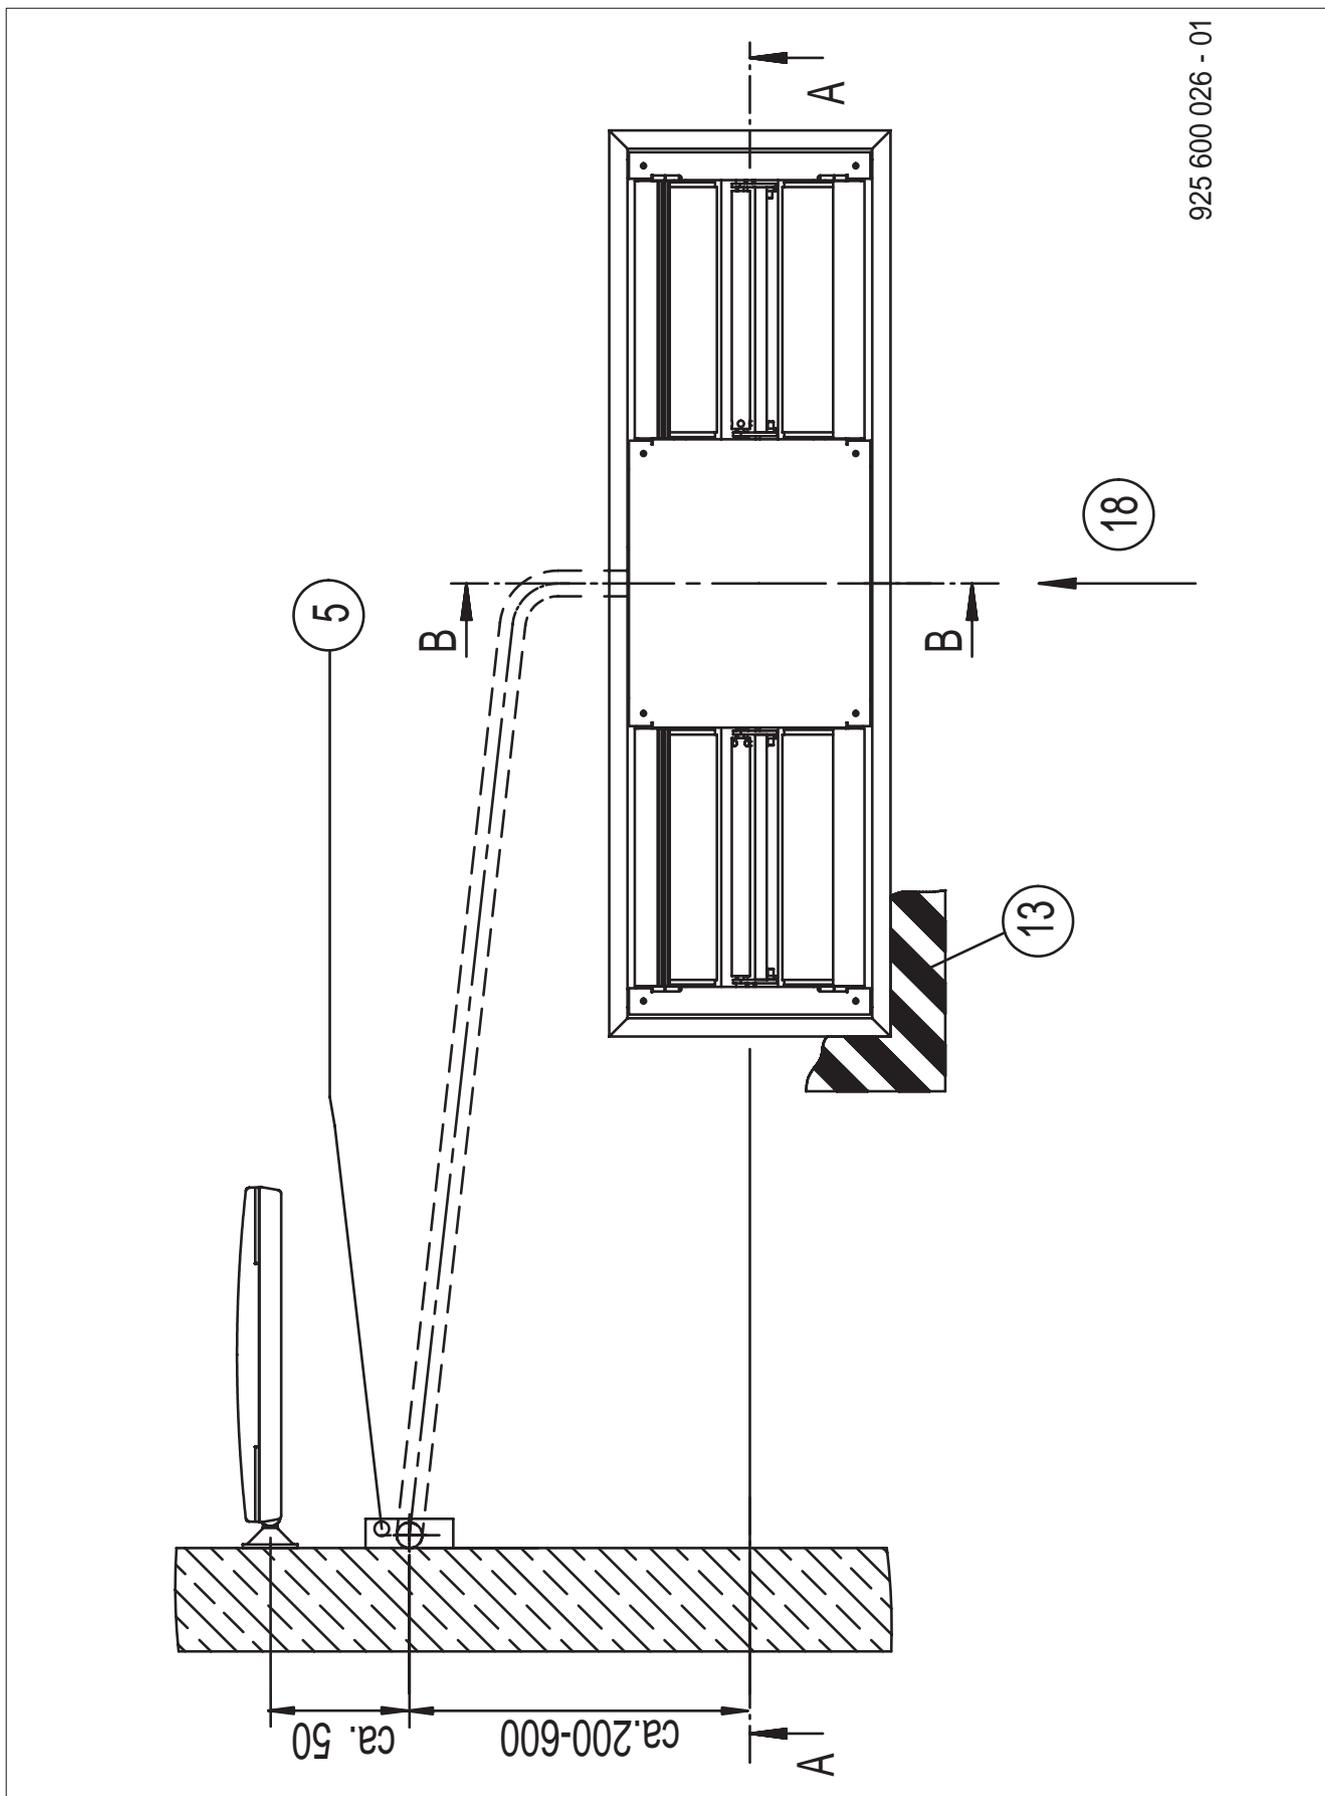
Installationsplan BD 6xx mit Wandhalterung - Grundriss
